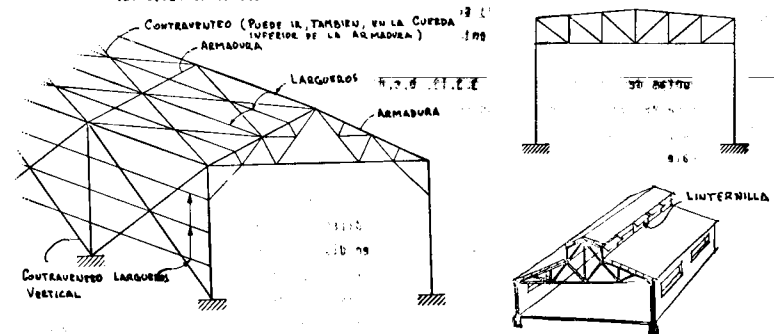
Cubiertas con armaduras usadas en naves industriales.
